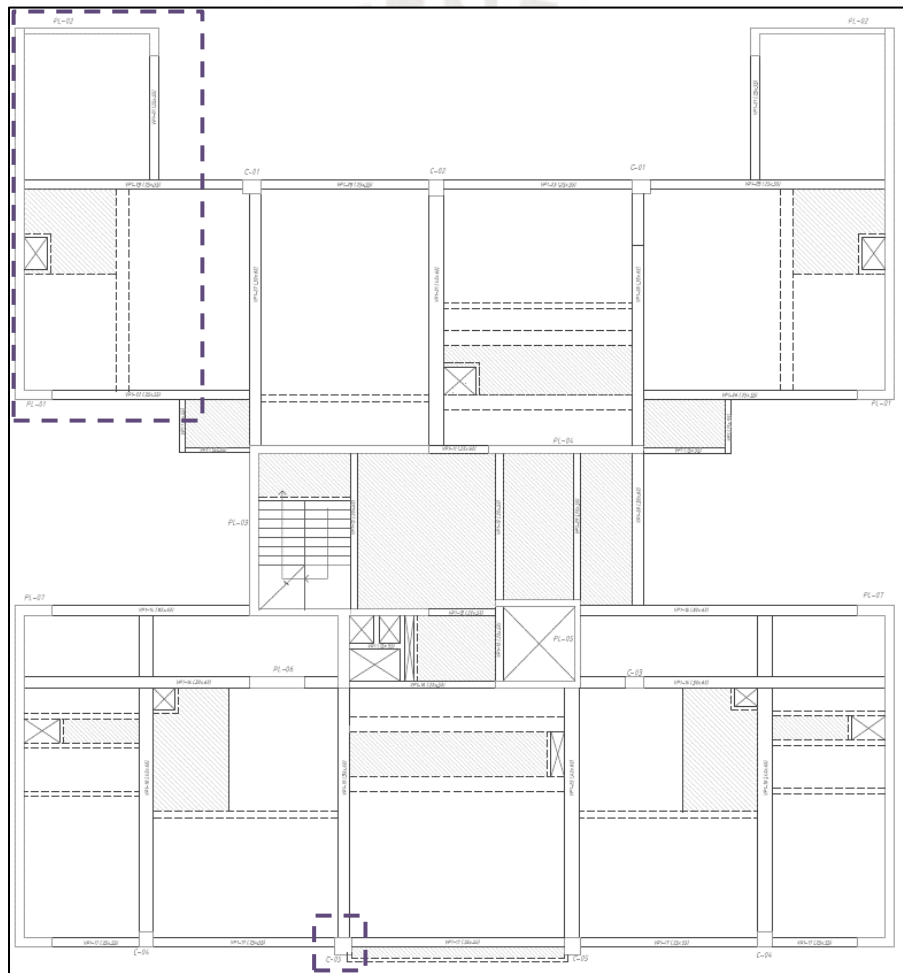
VISTA EN PLANTA DE LAS ZAPATAS A DISEÑAR.
